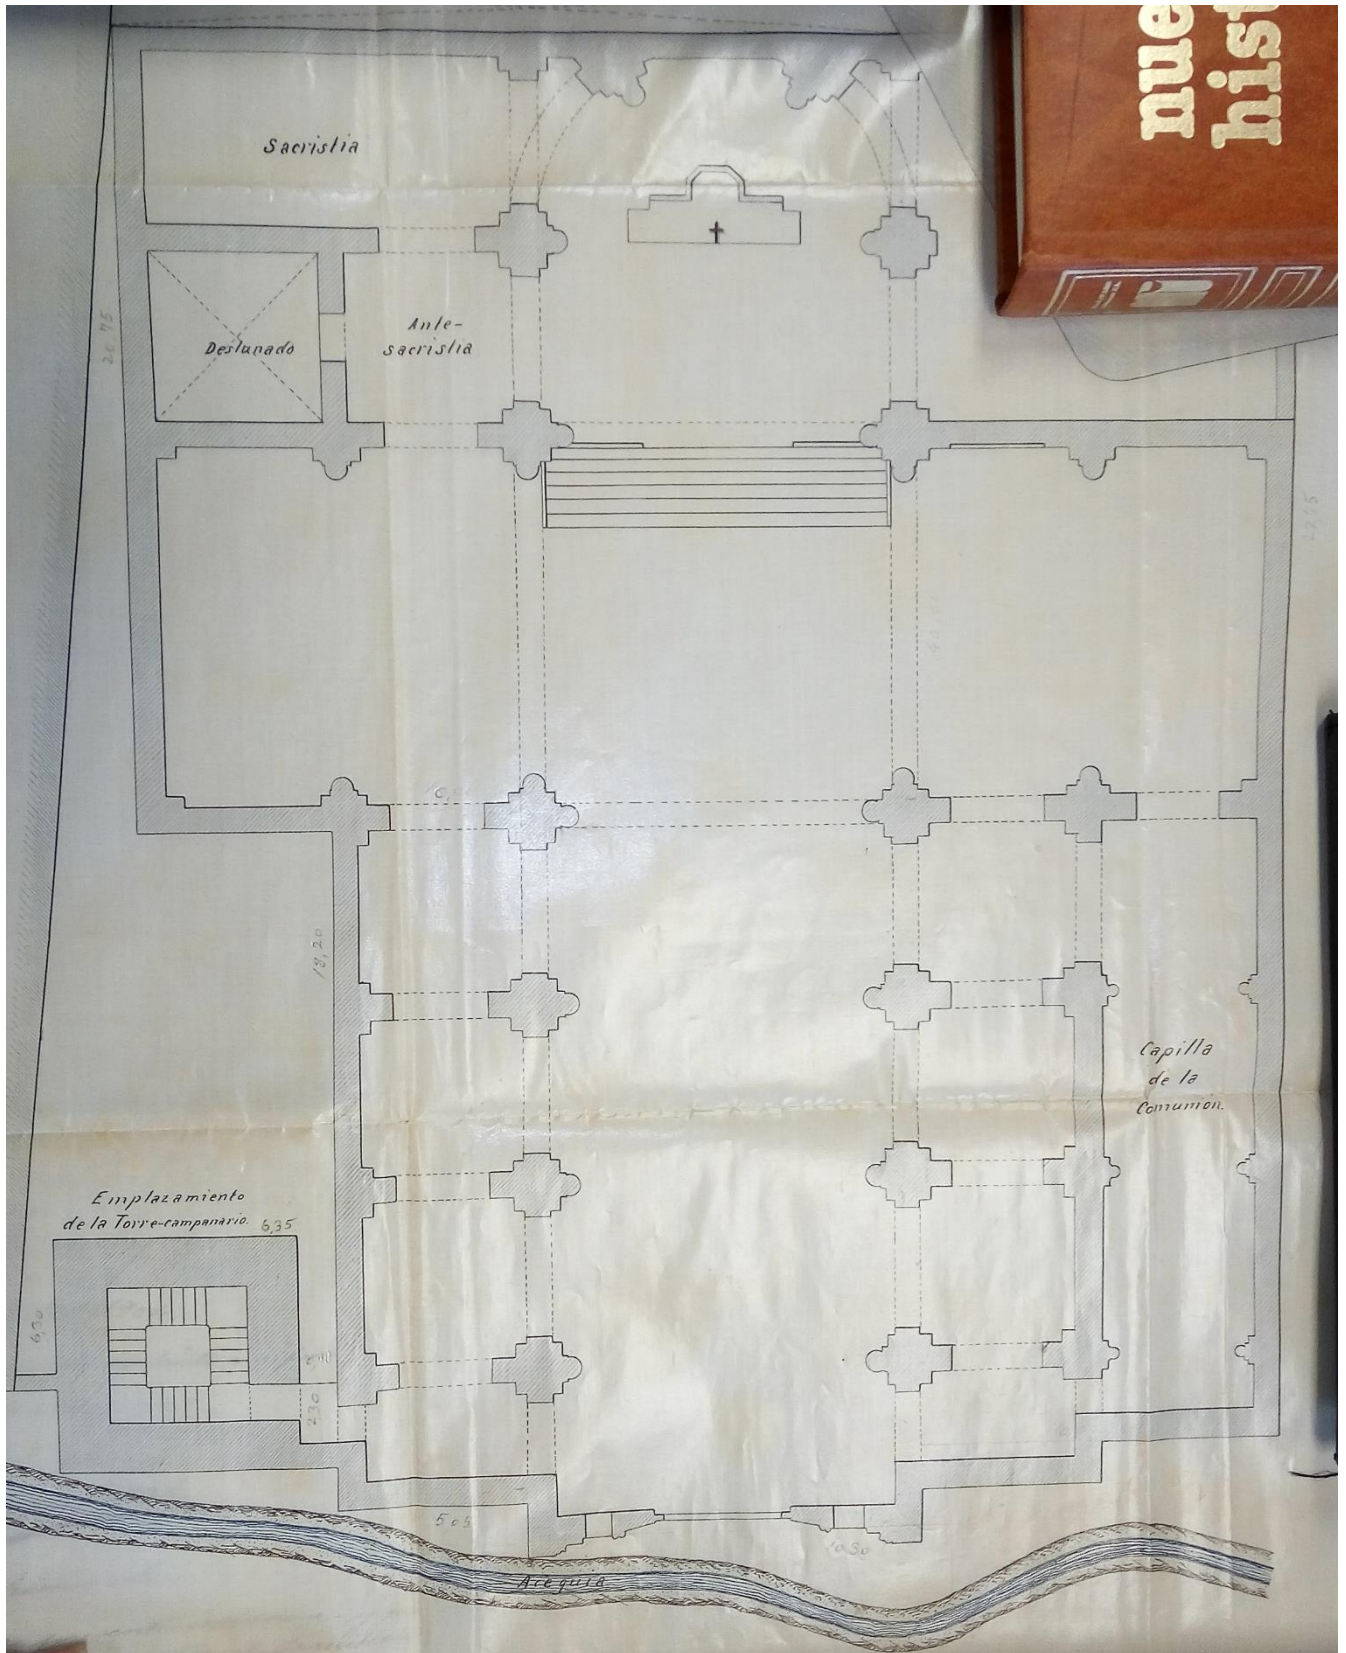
Plano de planta. Proyecto original del Templo de San Roque en Benicalap. Fuentes propias
